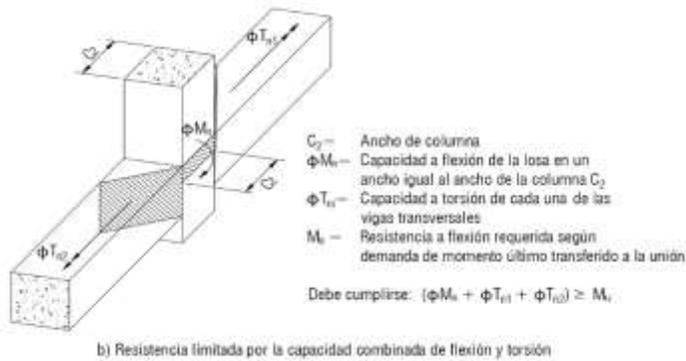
Ilustración de la transferencia de momento en las uniones con vigas transversales. (Tomado de ACI 352.1R-11, Fig. 5.3.2).
